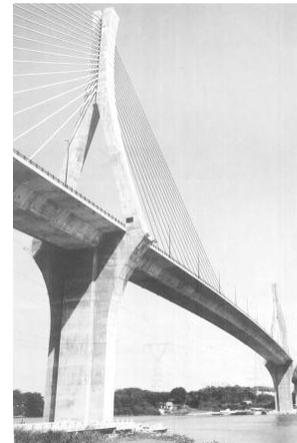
Puente Ing. Antonio Dovalí Jaime, terminado.
